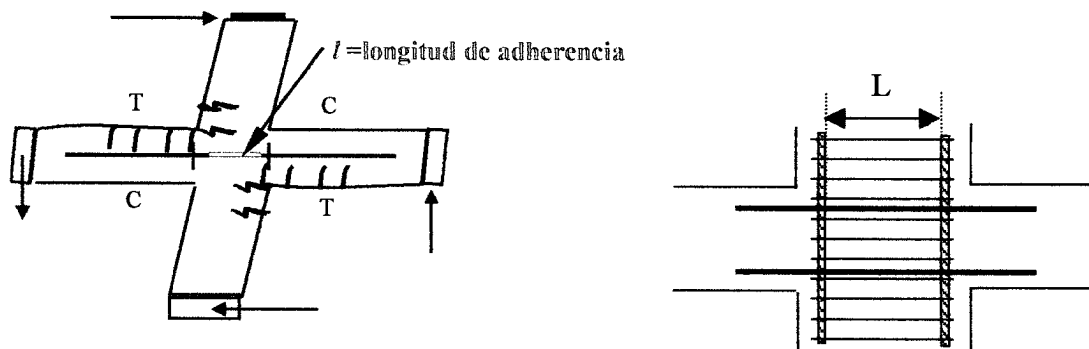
Longitud de adherencia en conexiones viga-columna interiores.
